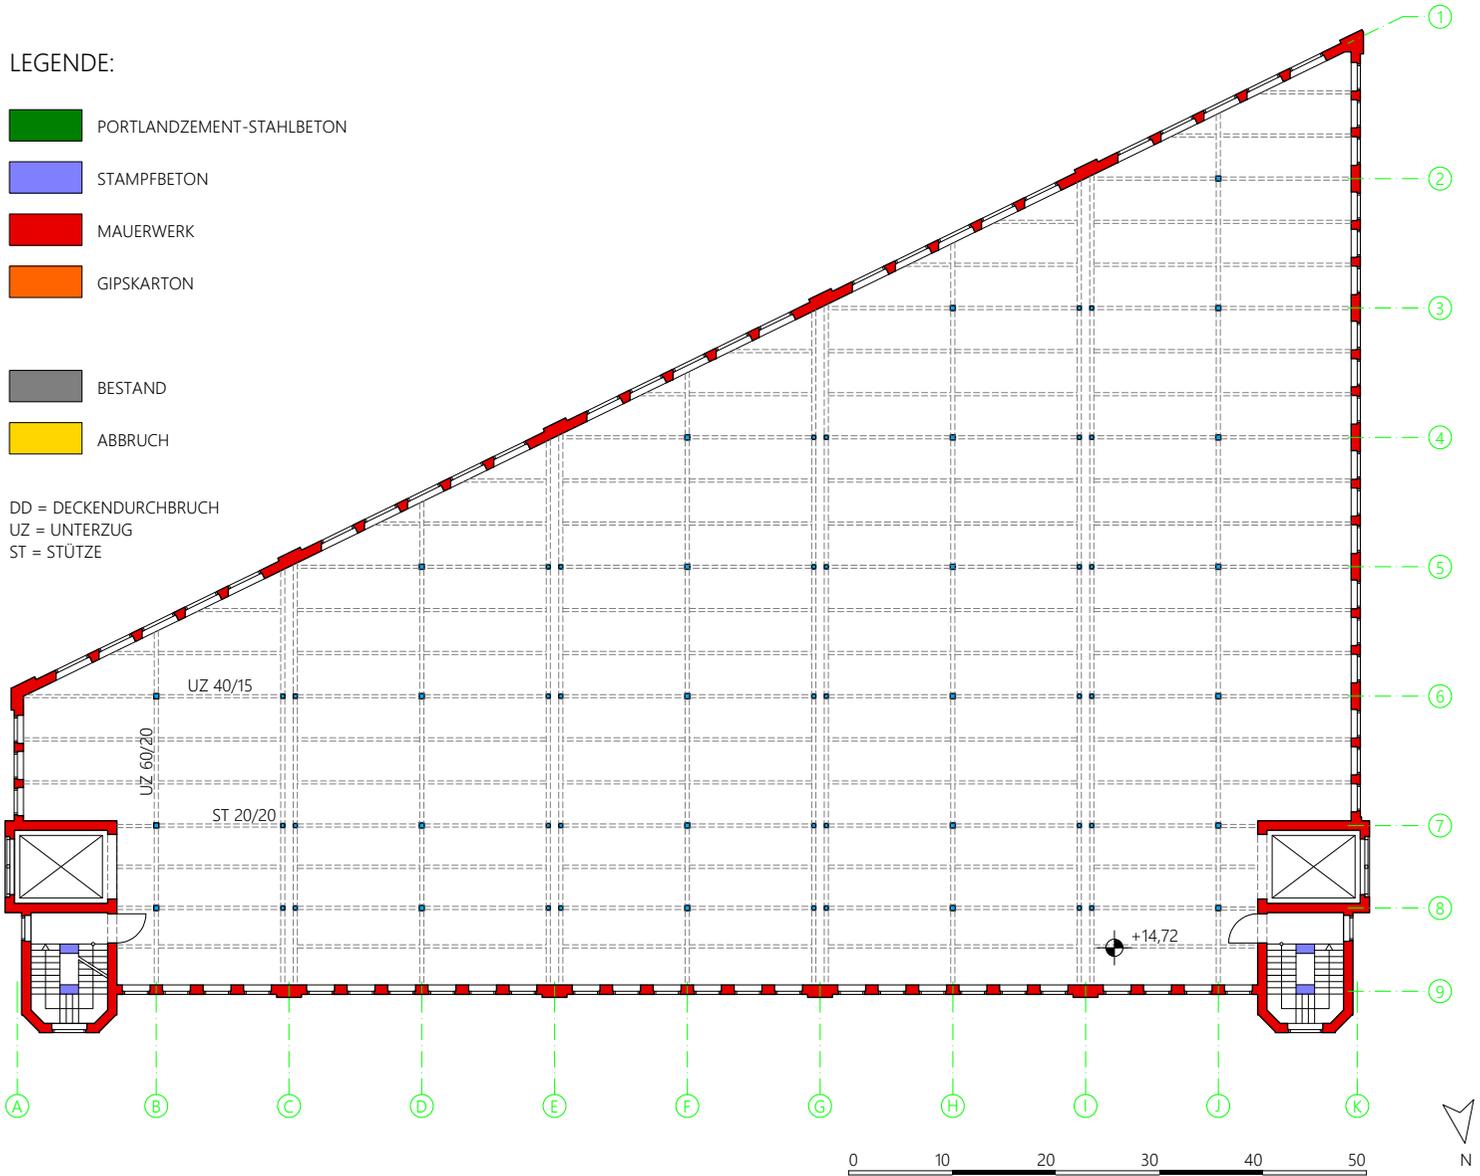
Bauphasenplan 1913: Dachgeschoß des Maschinenmagazins
